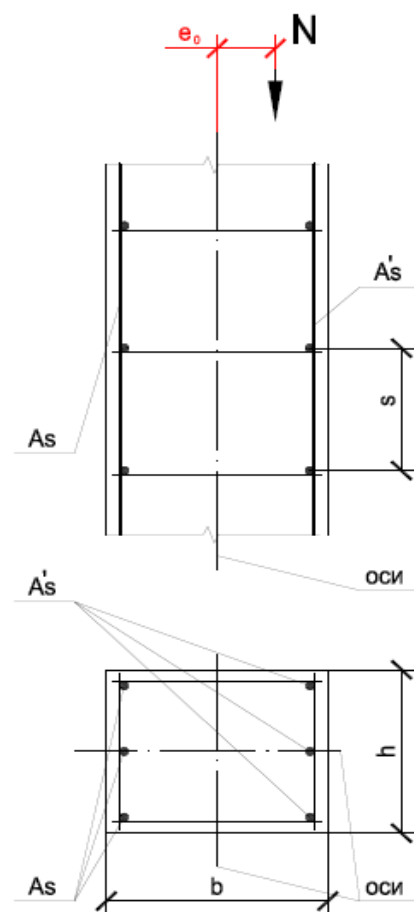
Способ армирования поперечного сечения несущего вертикального элемента при внецентренном сжатии
